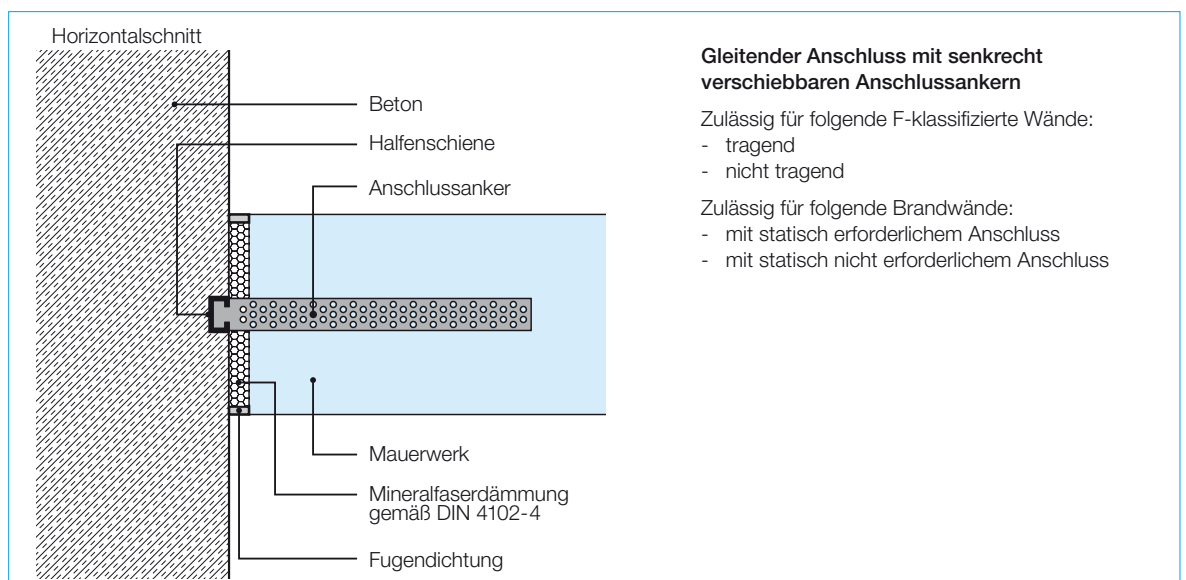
Seitlicher Anschluss von Mauerwerkswänden aus Porenbeton
